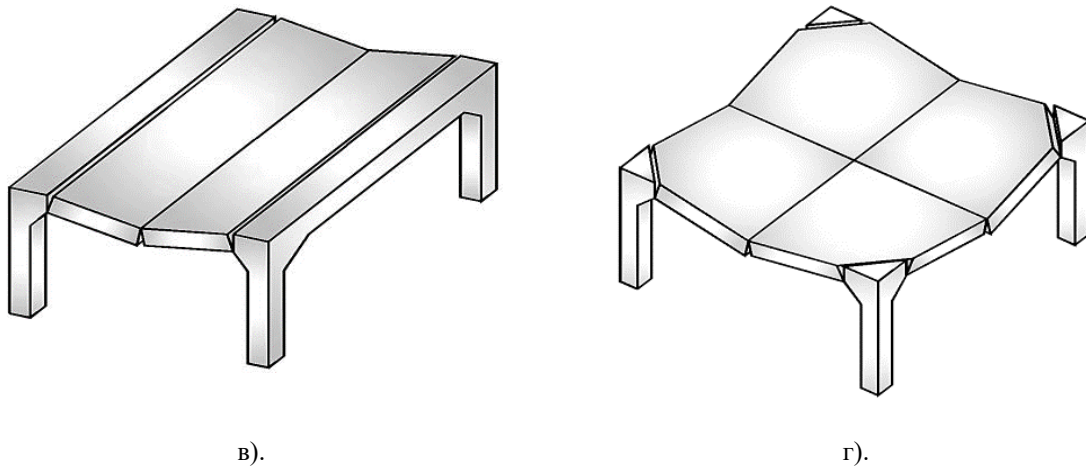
Схеми руйнування безбалкових перекриттів:
